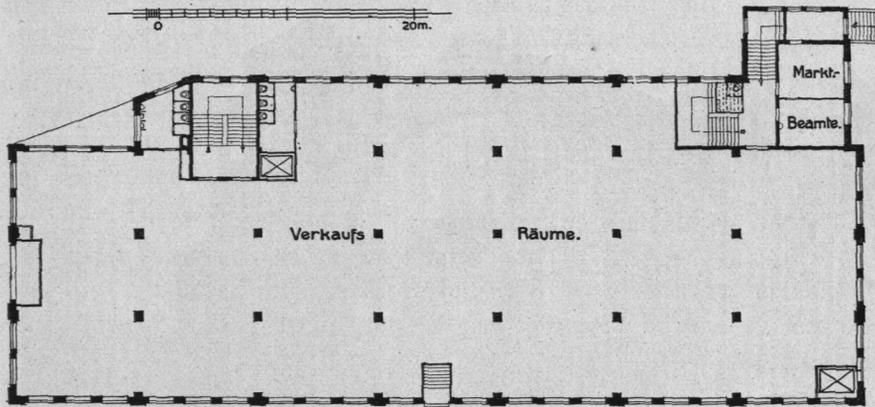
Marktanlagen am Deichtor, Blumenhalle, Erdgeschos, Grundriß.
